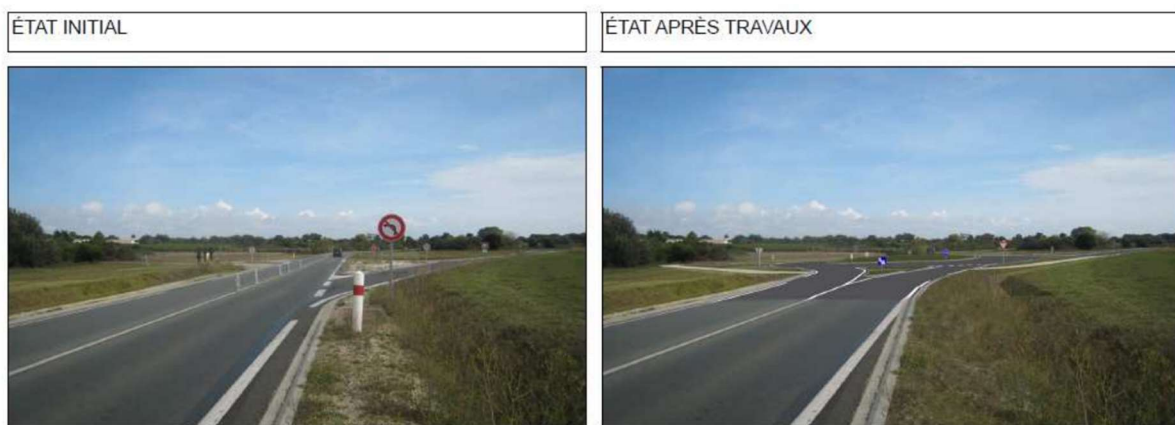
Photographies avant-après travaux au droit du giratoire du Défend
